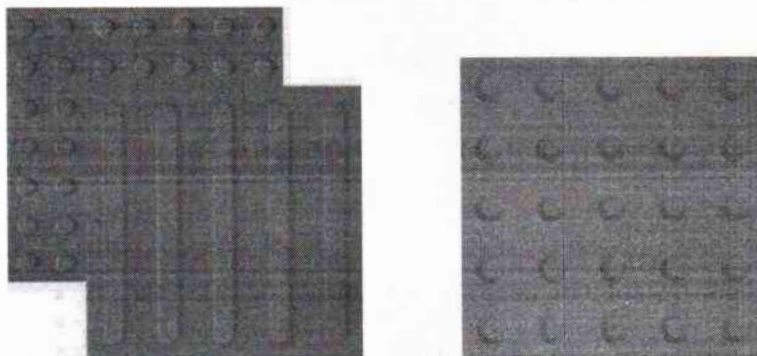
imagens exemplificativas de piso tátil de concreto – Cores: vermelha e amarelo
